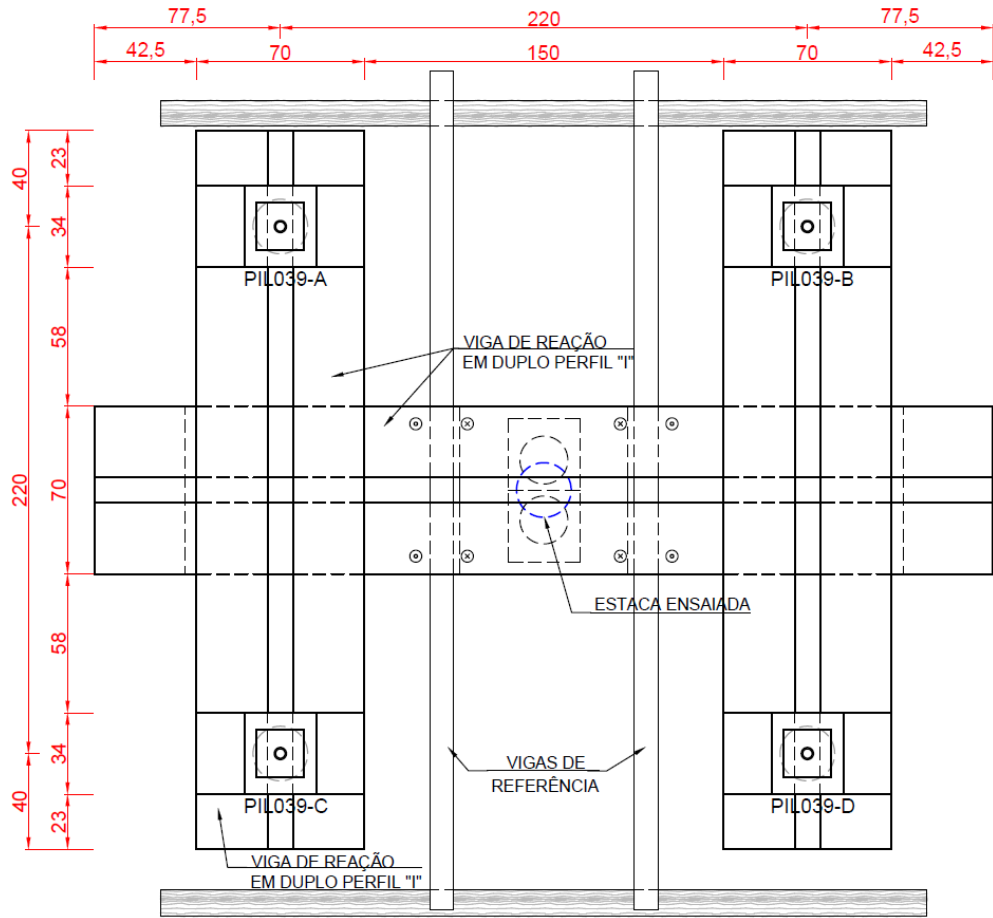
Planta do sistema montado para execução da prova de carga.
